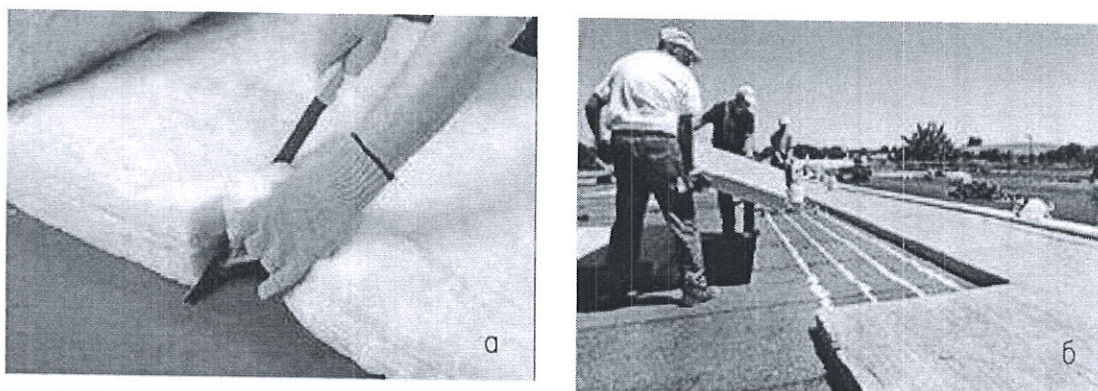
Укладка плит утеплителя вручную: а - нарезка плит по размерам; б - укладка плит
